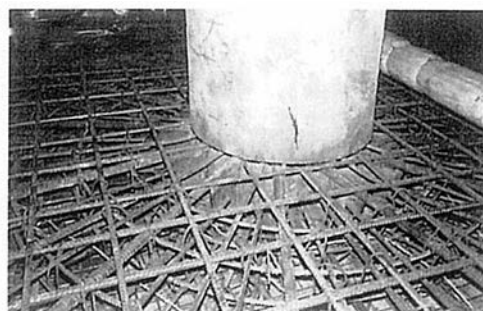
Дополнительное радиальное армирование сопряжения сваи-колонны с перекрытием, изображенном на рис. 2.
